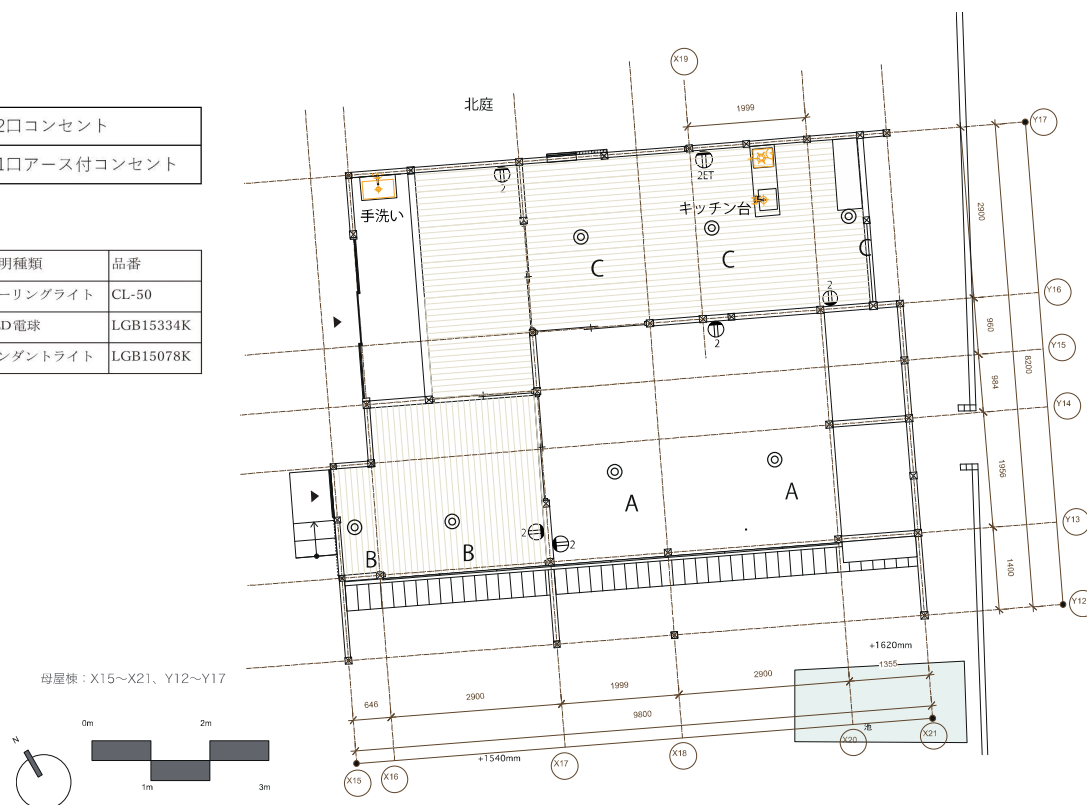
平面図及び照明位置、コンセント位置図（2017年9月）
